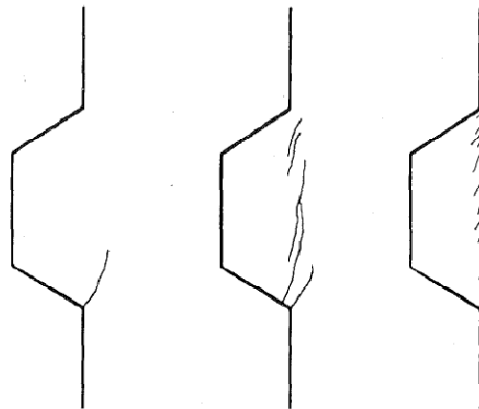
Esquemática da sequência do desenvolvimento das fissuras na juntas secas.
